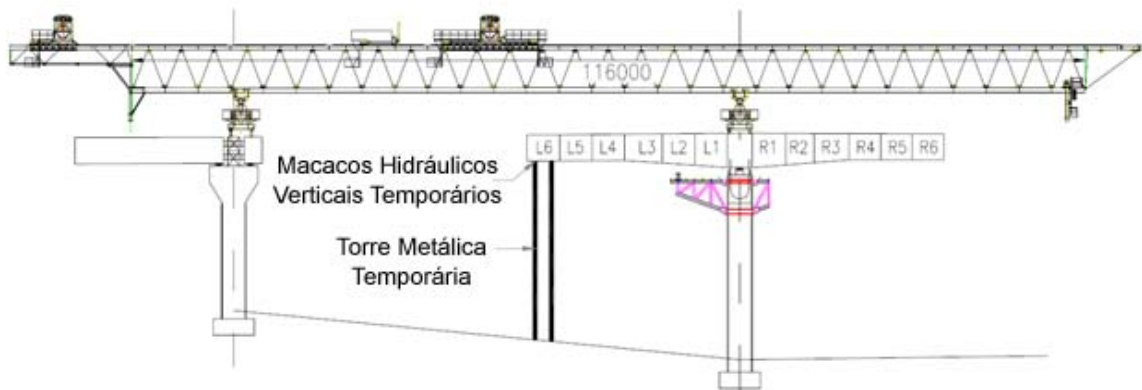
Esquemática da torre metálica estabilizadora.
